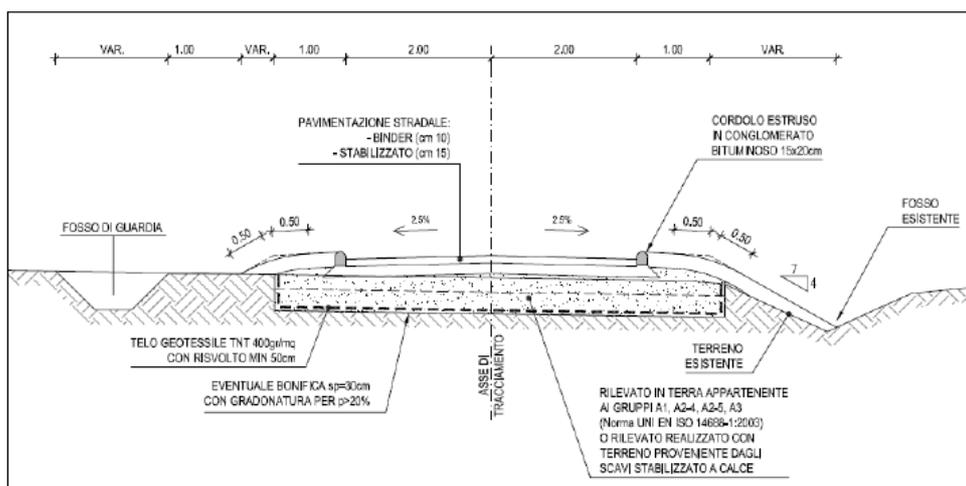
sezione tipica collegamento abitazione di Vicolo dei Prati.
